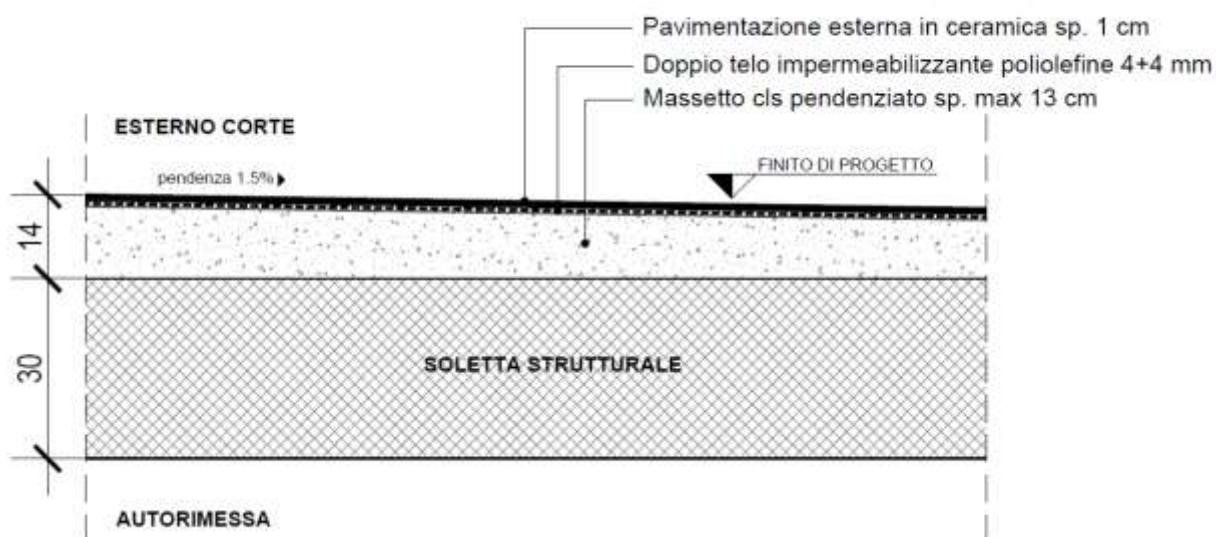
dettaglio della porzione di solaio della terrazza impianti previsto sopra l'autorimessa
